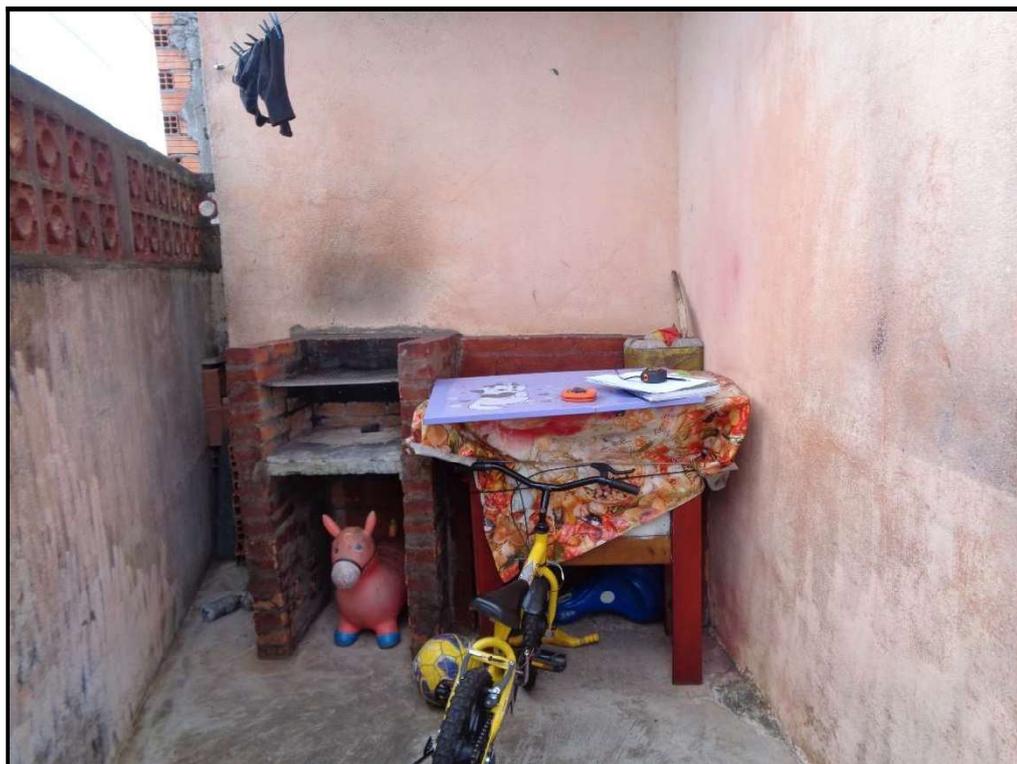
Vista pelo quintal da chegada à área de serviço
